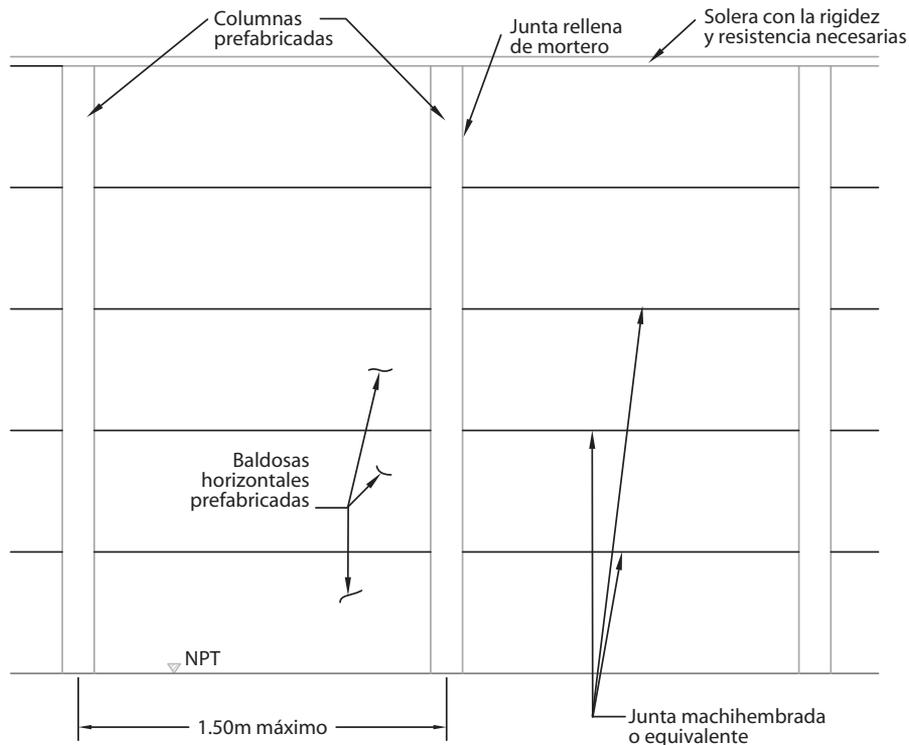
Paredes prefabricadas tipo baldosas horizontales.
